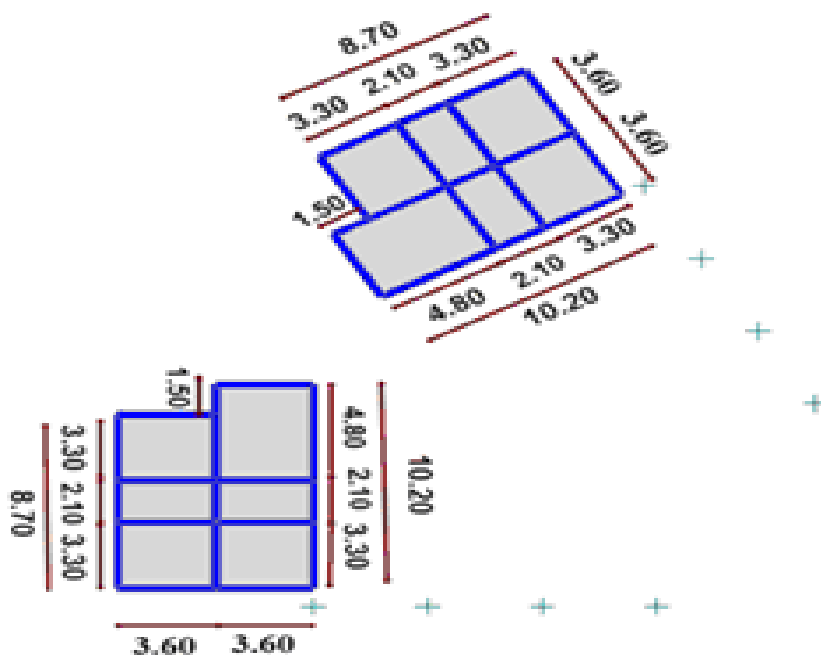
Vue en plan 2D, le plancher de 2^{eme} sous sol (h=-4,08m)
